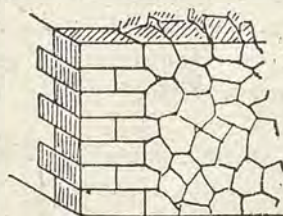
Muratura di pietra greggia con spalla di pietra da taglio.
